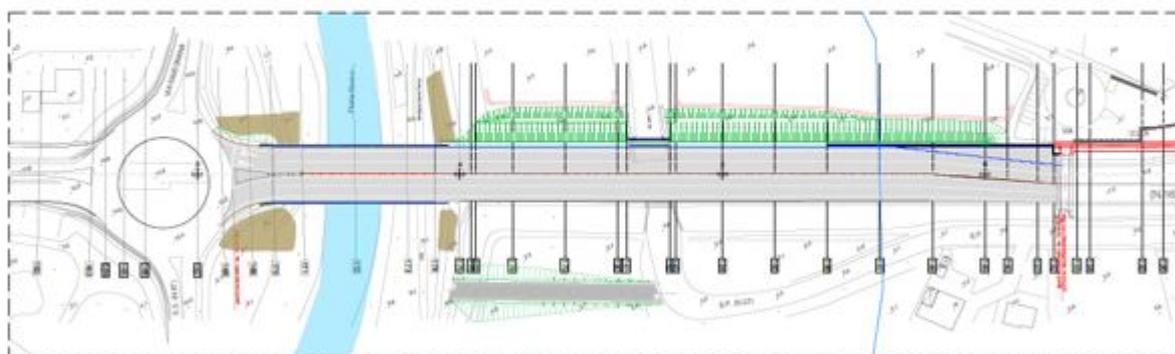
Planimetria degli interventi mitigativi - TRATTO B (T02IA00AMBPP01\_B)
